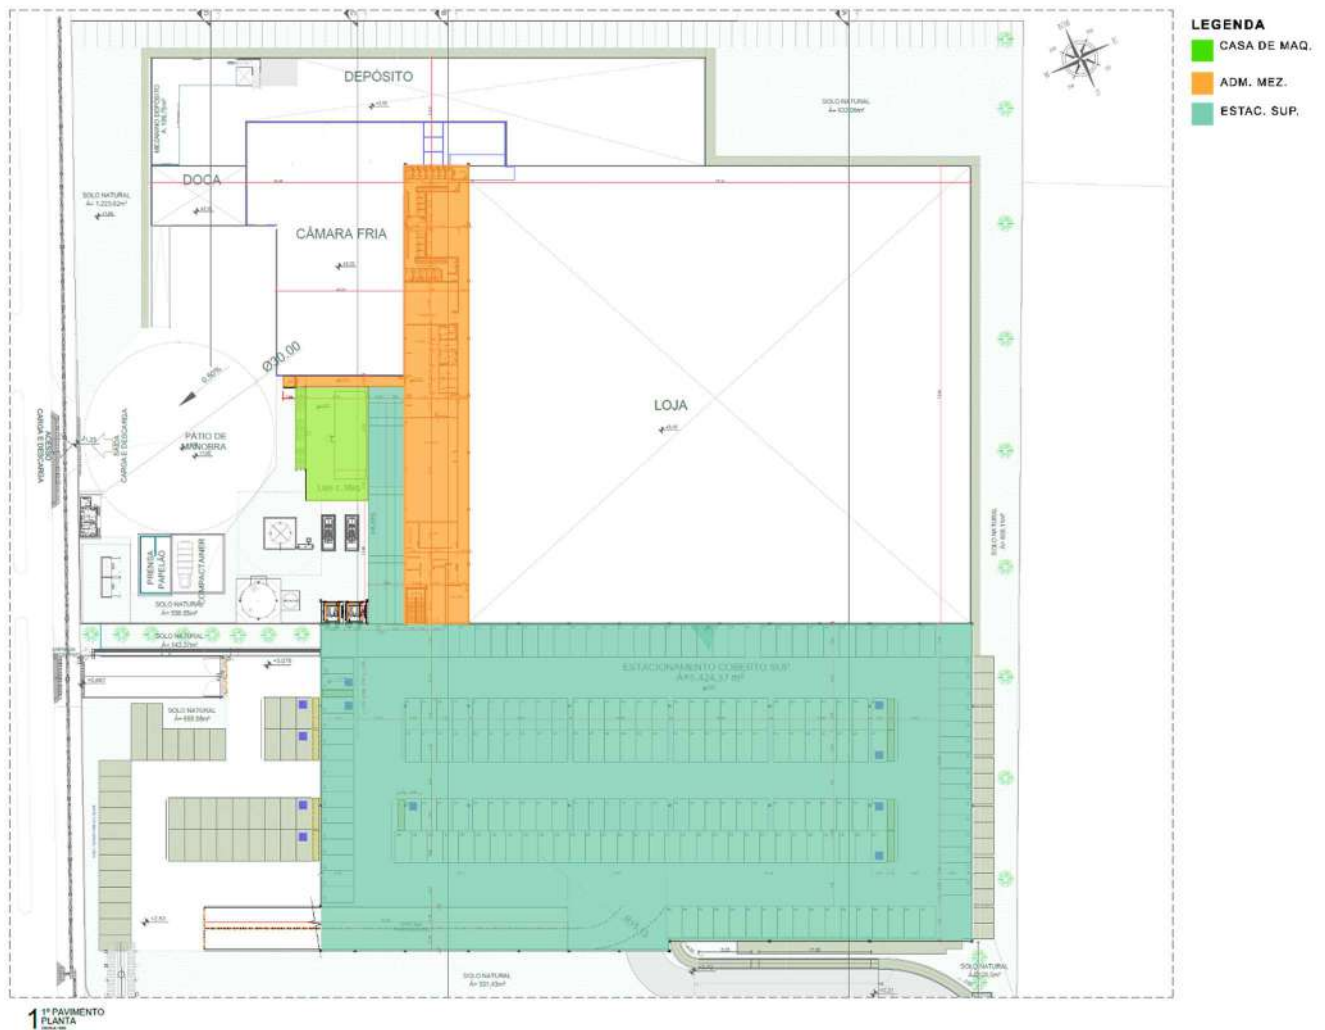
Diagrama dos ambientes - Planta Baixa Mezanino.
